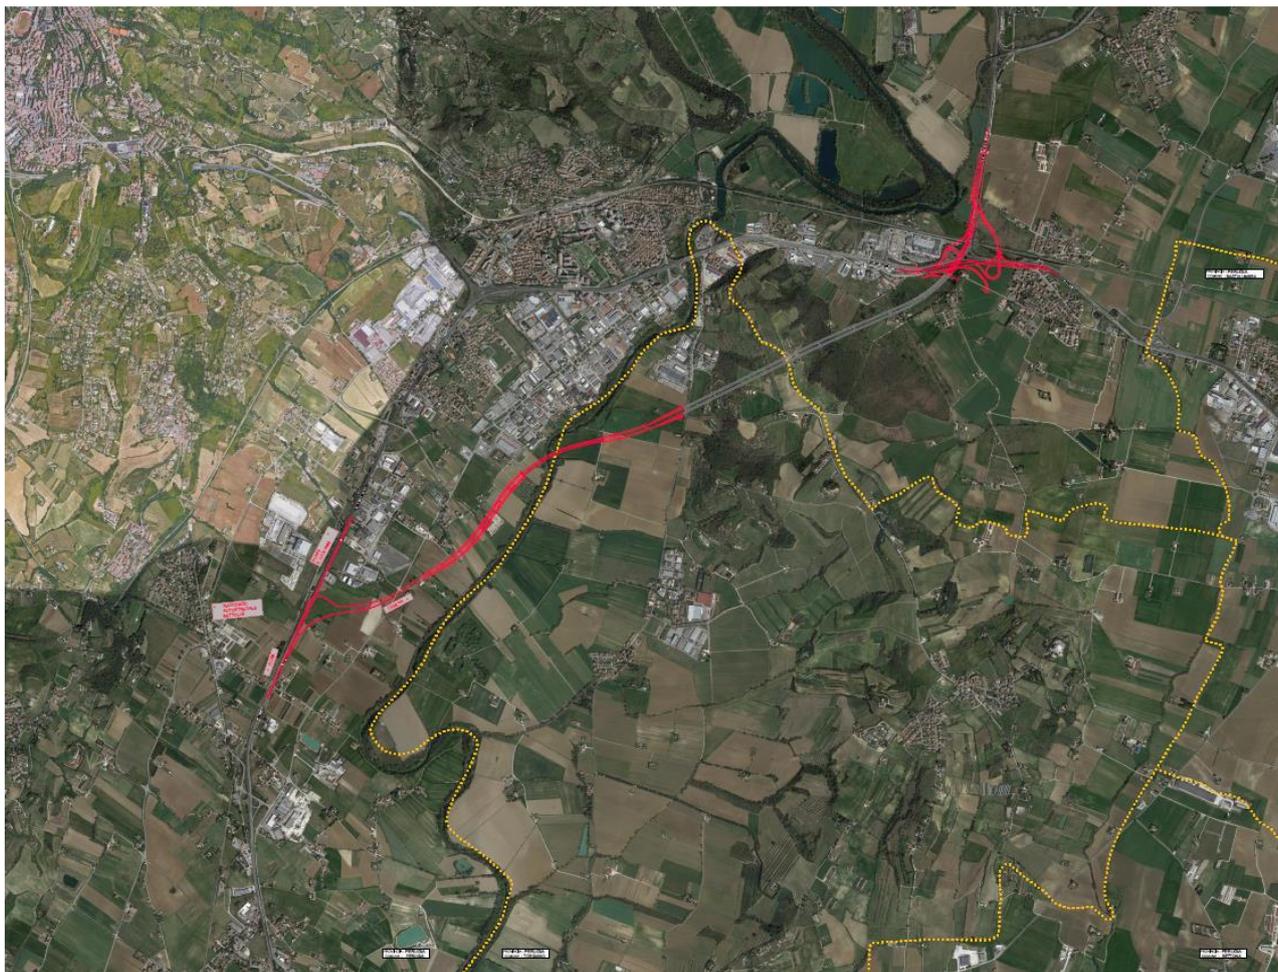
Localizzazione del Progetto Definitivo - Tratto Madonna del Piano – Collestrada su base ortofotografica
